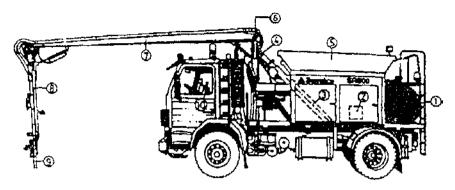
Установка «Савалко 8К800» в рабочем положении: 1 – бак для вяжущего; 2 – воздушный компрессор; 3 – шнек подачи щебня; 4 – гидромотор привода шнека; 5 – емкость для щебня, 4 м³; 6 – кронштейн для поворотной выдвижной стрелы; 7 – стрела; 8 – штанга; 9 – распределительный насадок; 10 – кабина водителя
